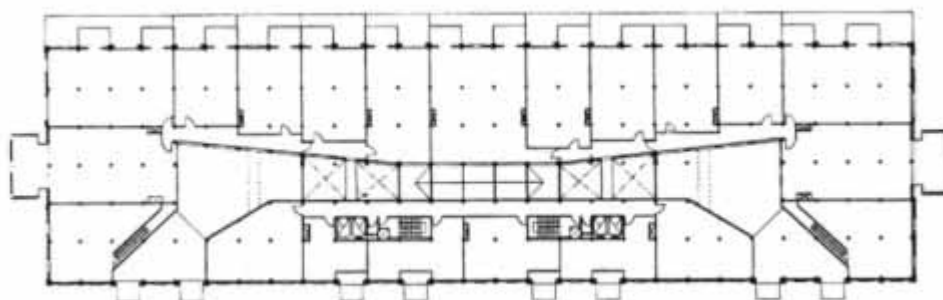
planta 1º pavimento do Galpão 5, onde se distribuem as unidades habitacionais. Fonte: Revista Arquis nº 1.
